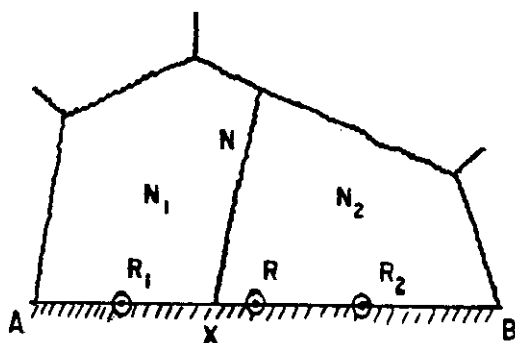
ELEMENTO DE LAJE ADJACENTE A UMA VIGA AB
